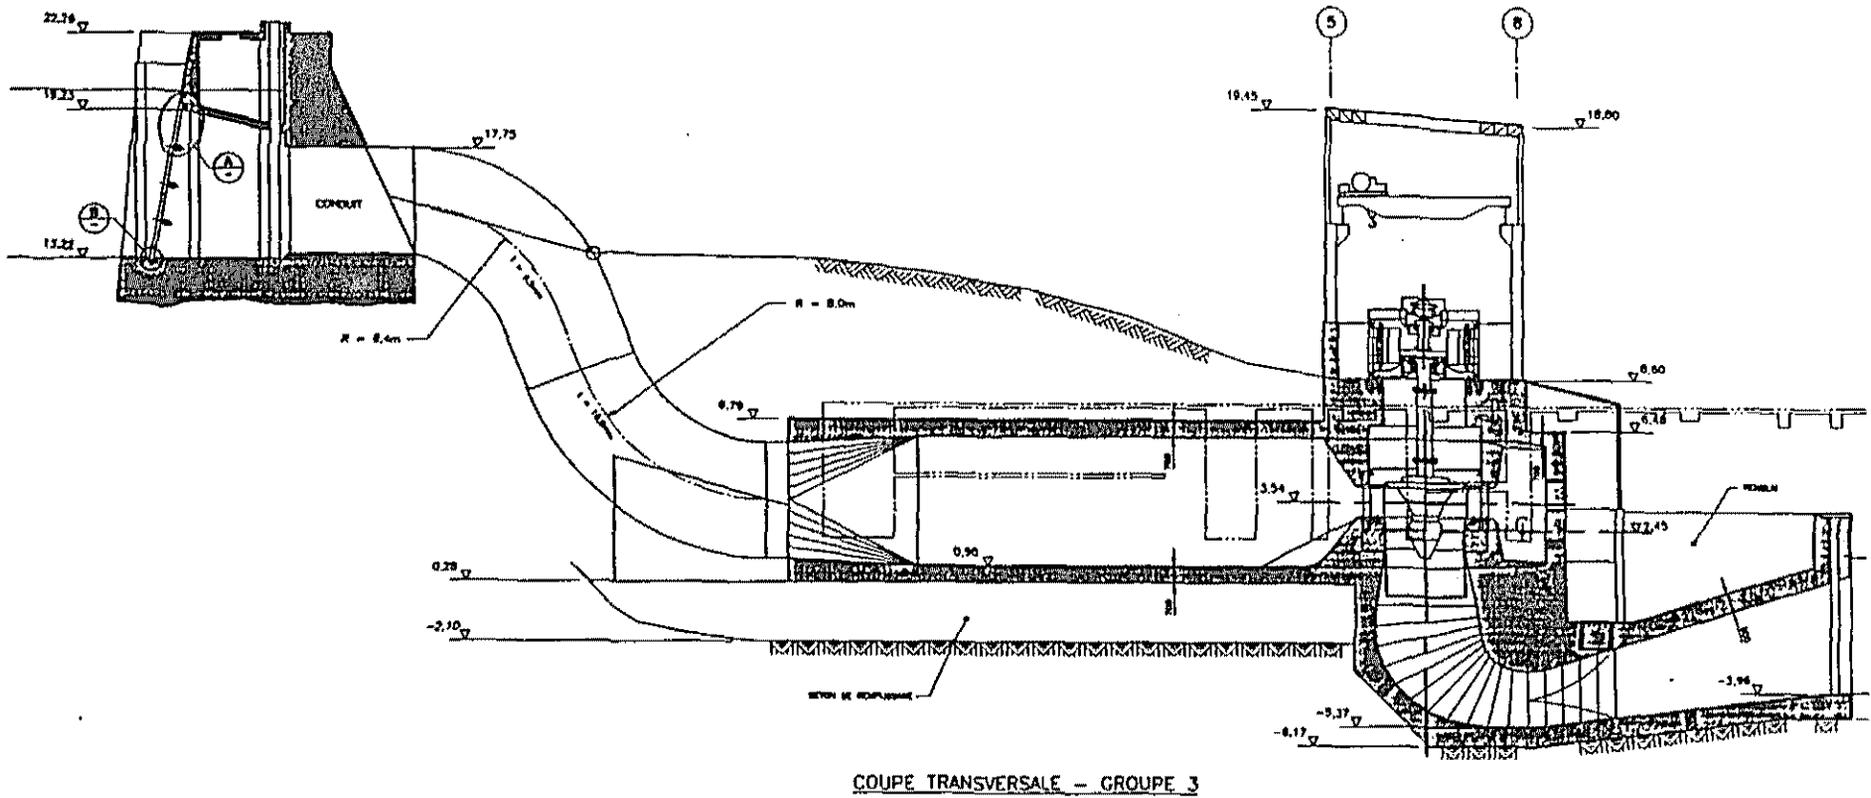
Coupe longitudinale du groupe turboalternateur N°3
